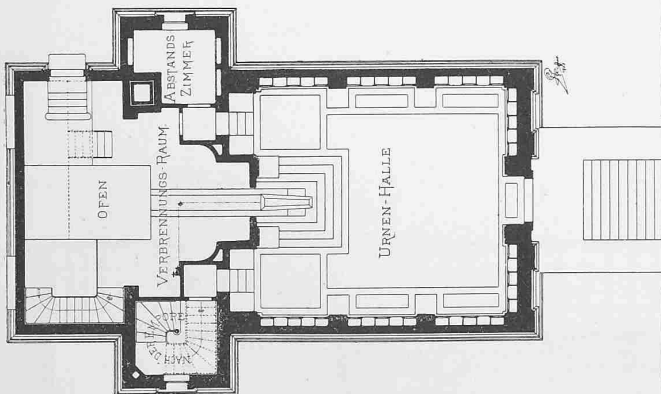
Grundriss vom Erdgeschoss. — Masstab 1:250.
